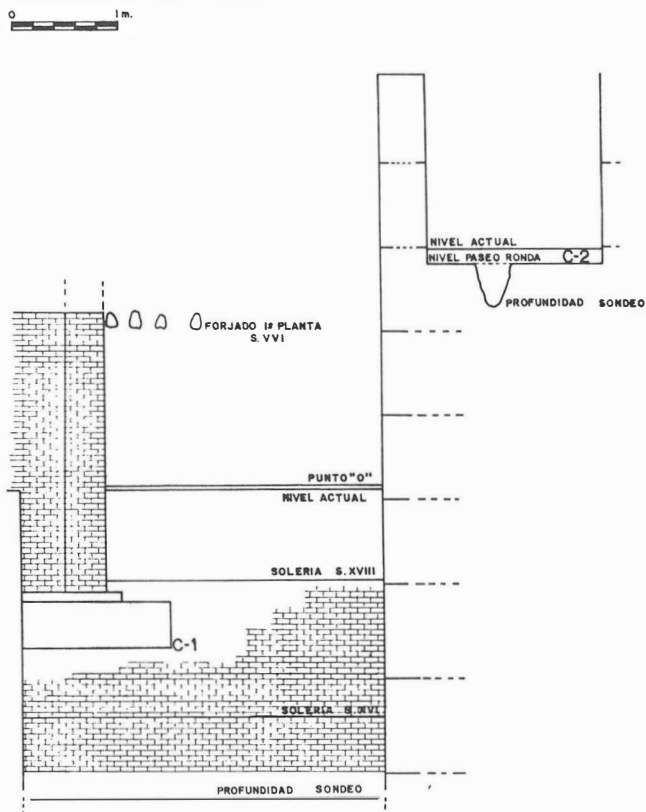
Excavaciones Casa de La Moneda/86. Sector Fundición. Planta C-1.
